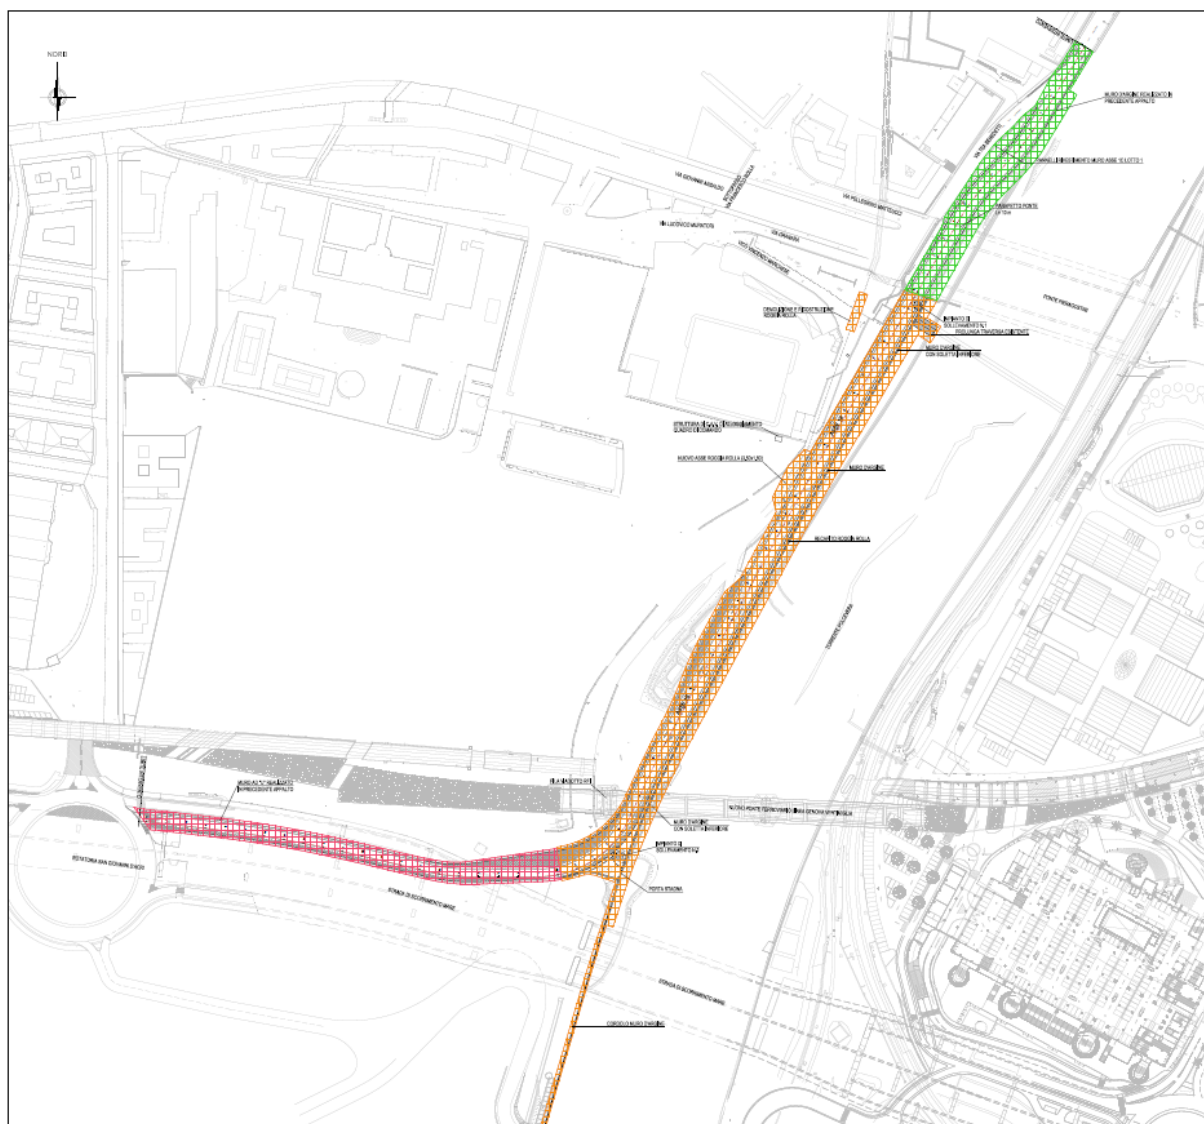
Planimetria di progetto con individuazione del sub lotti (sub lotto 3: arancione – sub lotto 1: verde – completamento raccordo con strada urbana di scorrimento: rosso)
